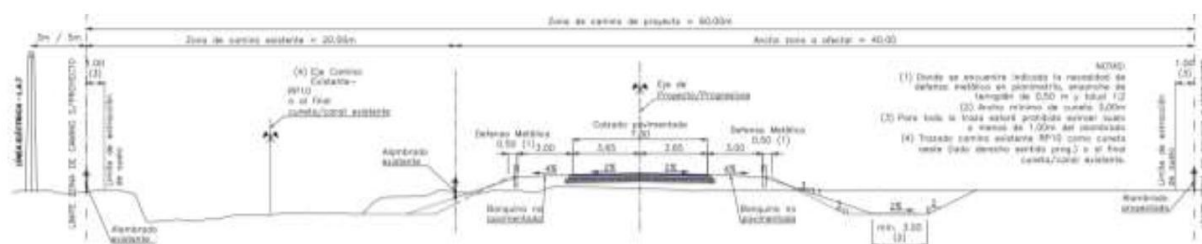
Perfil Tipo 2 – Rural – Obra Nueva – 21+660 a 37+509
